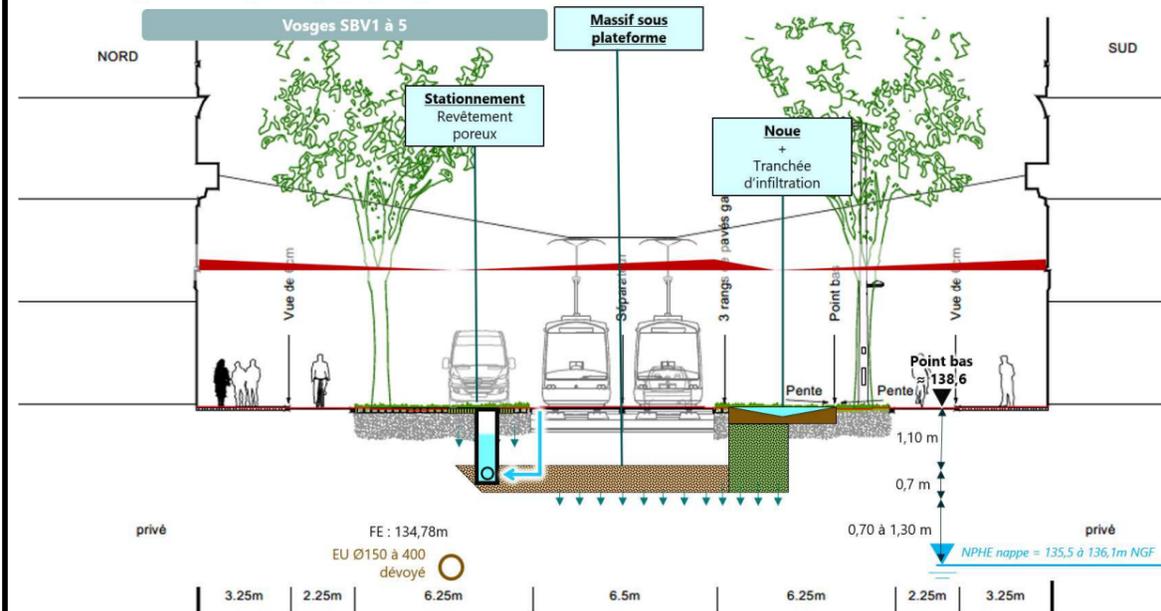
COUPE TYPE ASSAINISSEMENT AVENUE DES VOSGES (Source : GETAS AVP)
